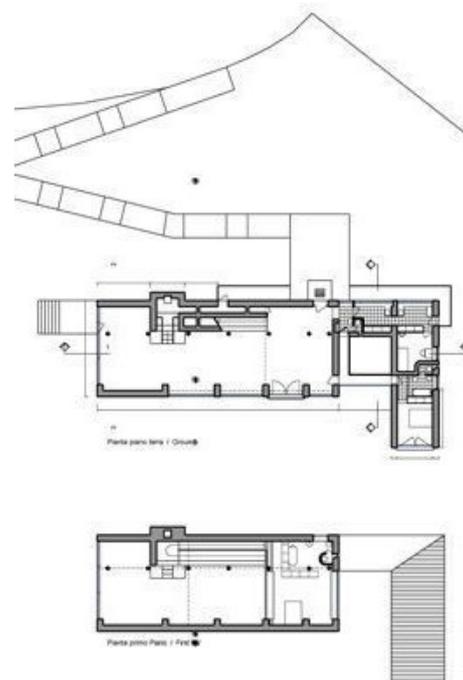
Plantas arquitectónicas de Casa Errázuriz
